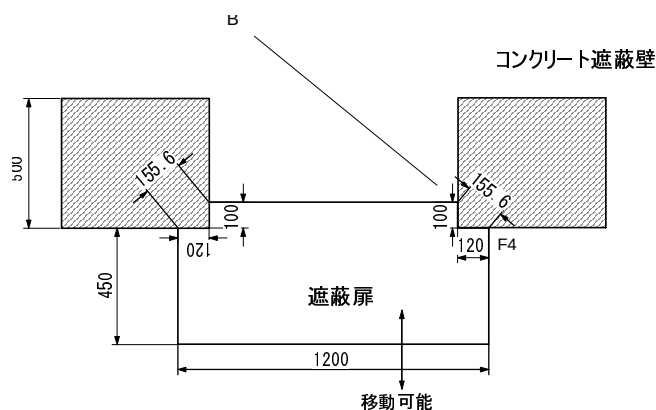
DR 室入口付近線量評価点 (F4) 平面図
